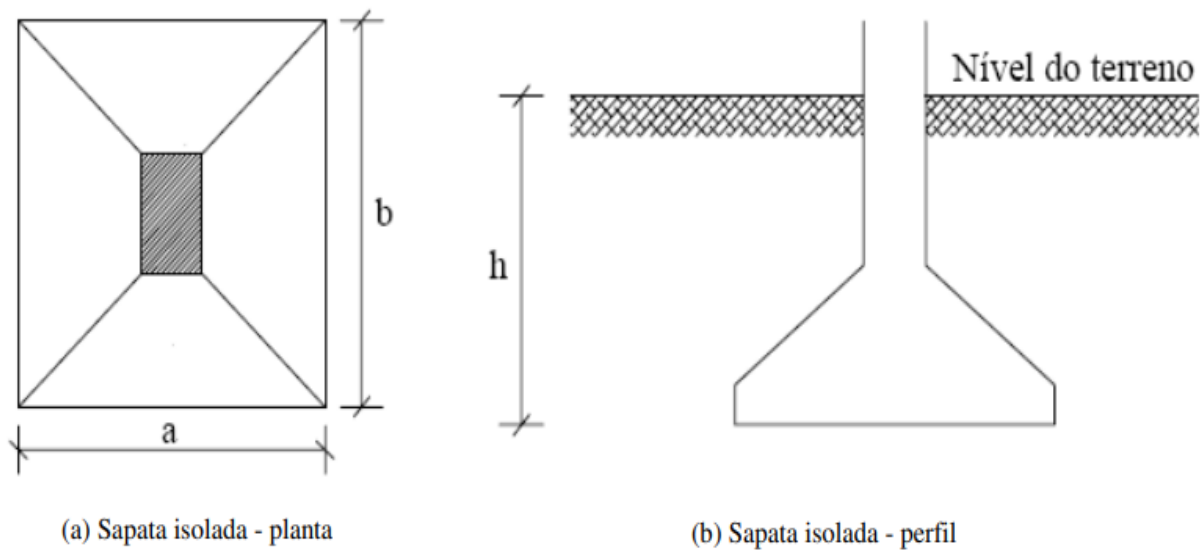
Sapata isolada com dimensões na vista em planta e na vista em perfil
